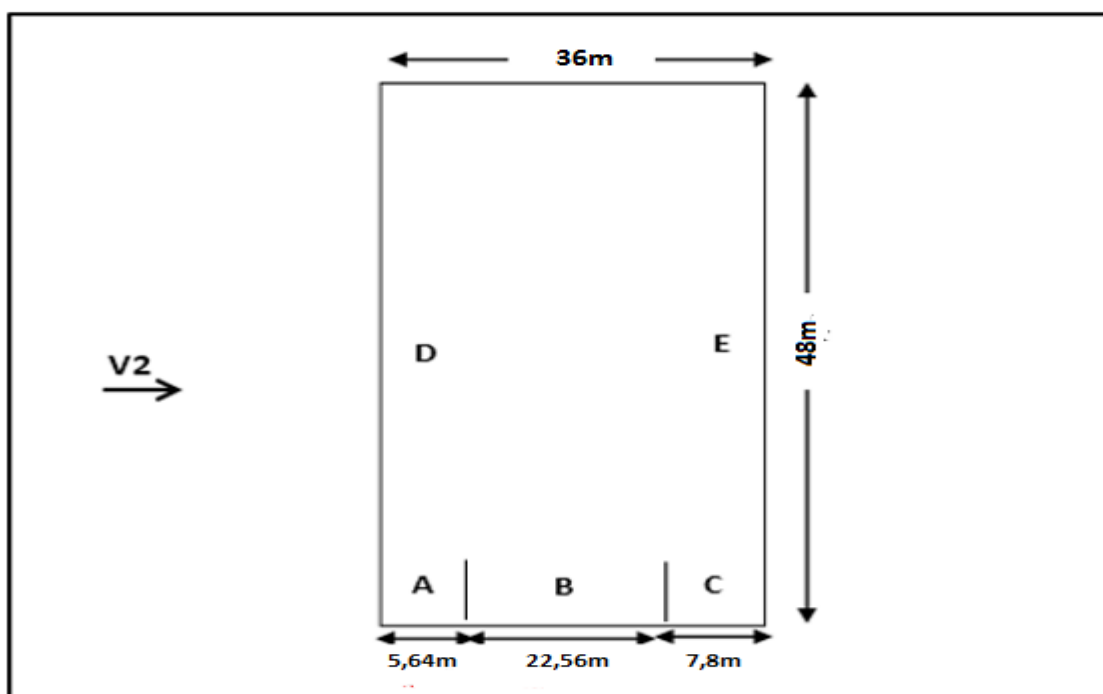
Vue en plan des zones de pression sur les parois verticales sens V2.
